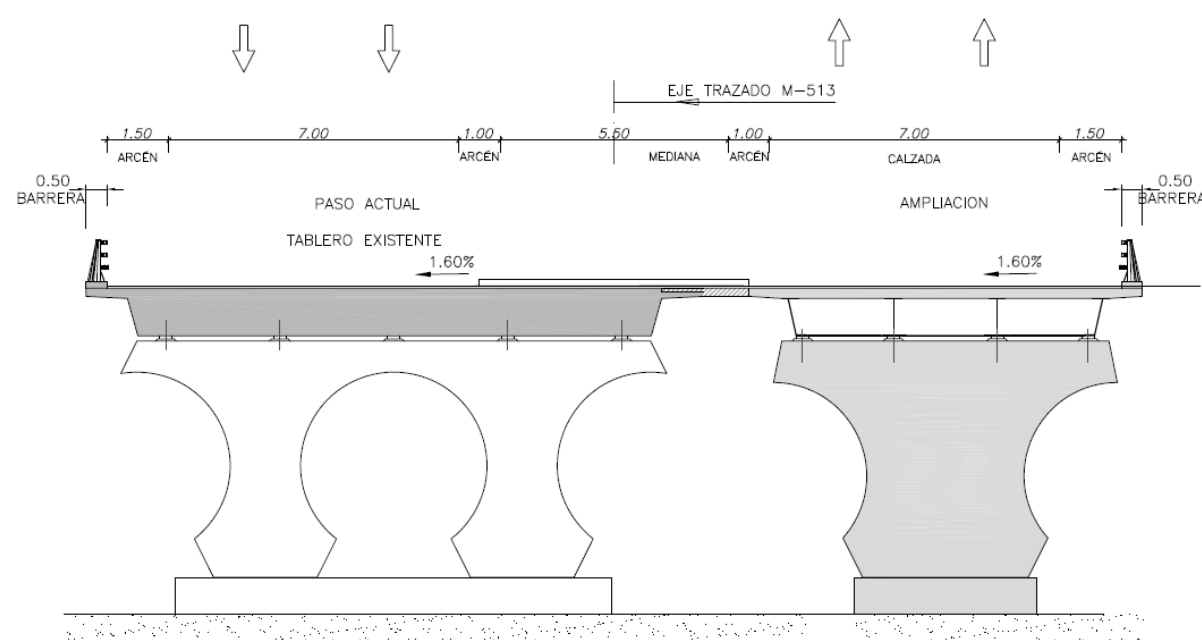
Sección transversal ESTRUCTURA 1 y estructura existente
